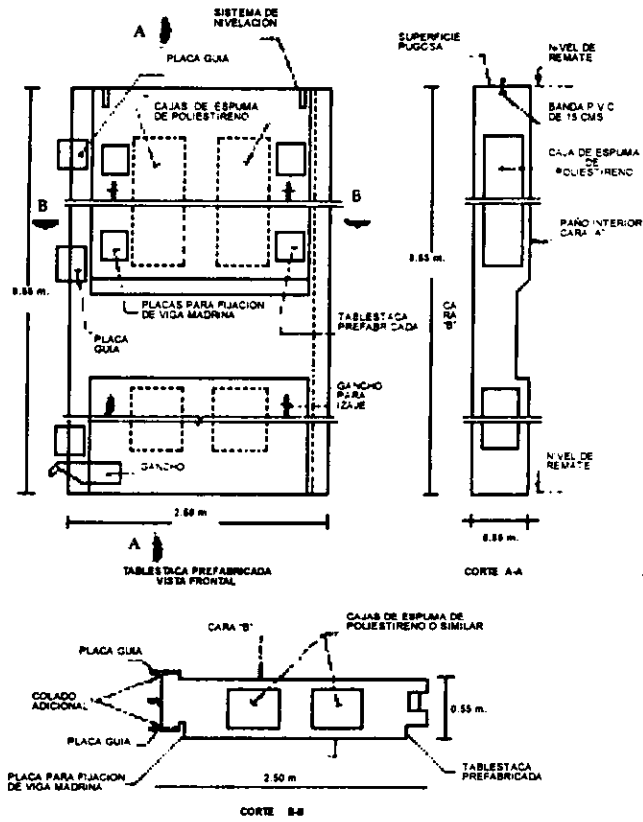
MURO TABLESTACA PREFABRICADO.
